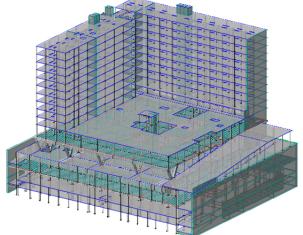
Modelo Estructural completo de la Zona Derecha y de la Zona Izquierda.
